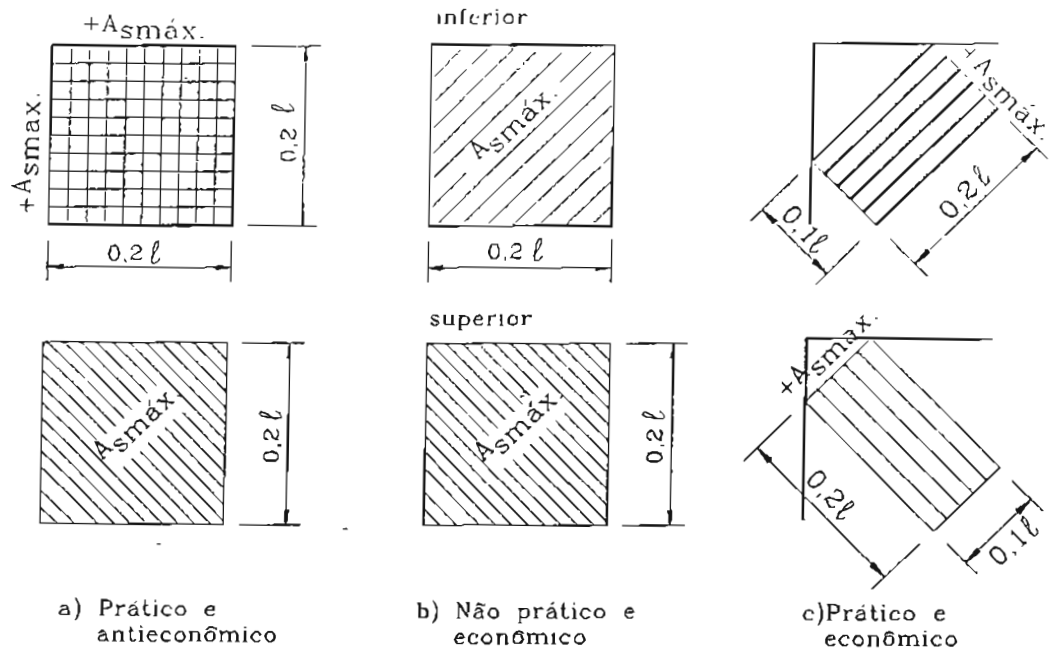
Armadura de canto segundo NBR 6118 (1978)
